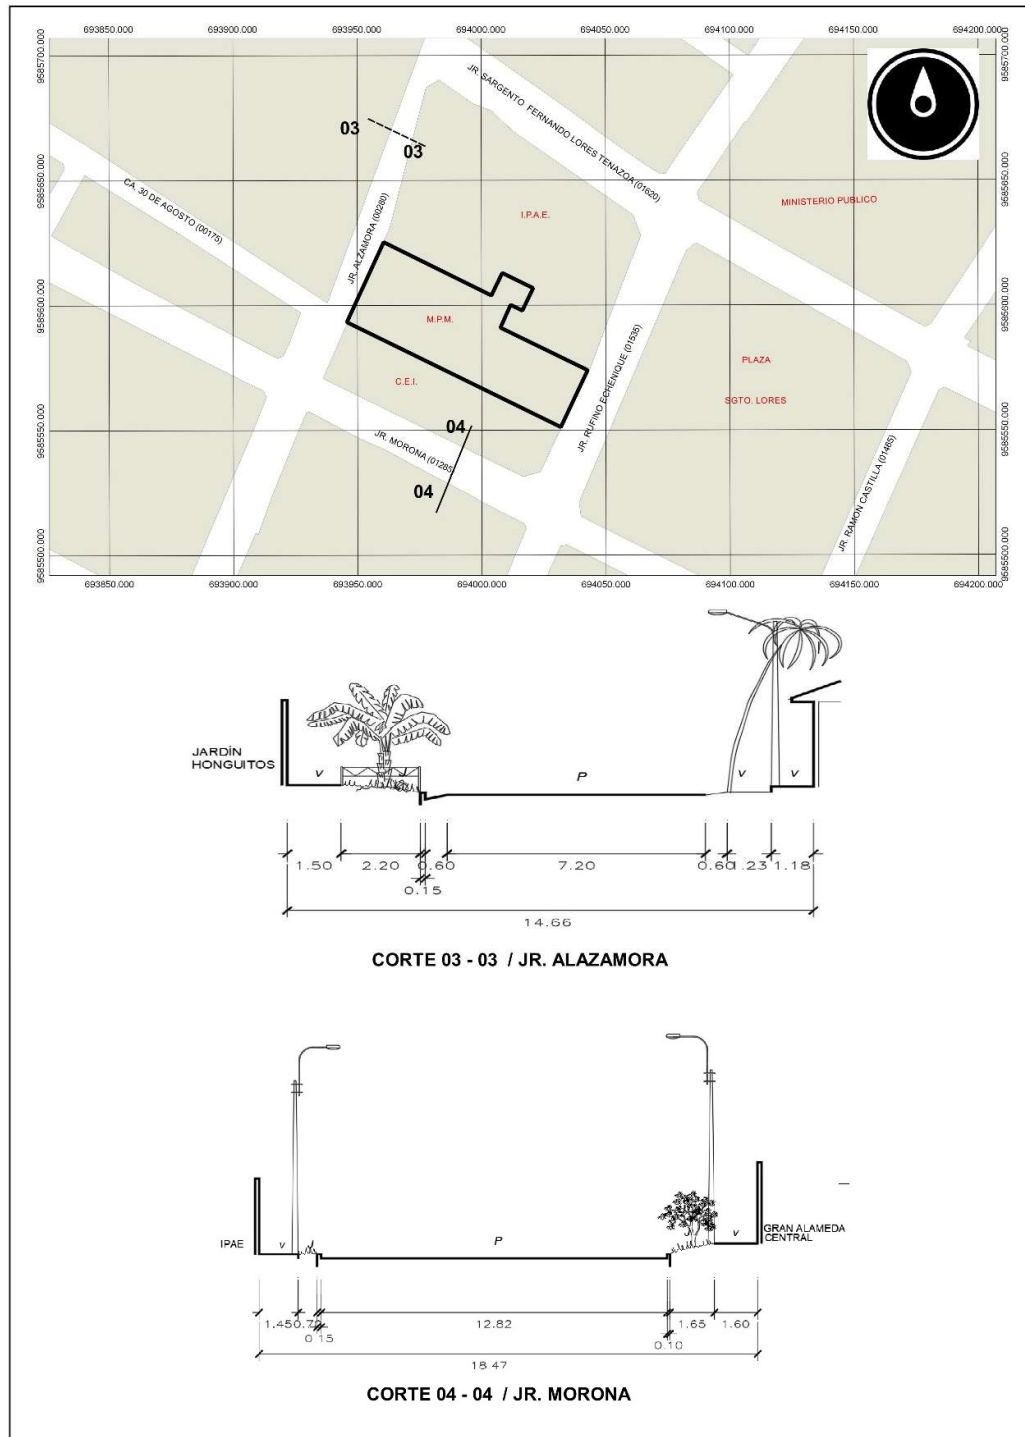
Plano de Secciones Viales / Jr. Morona - Jr. Alzamora
